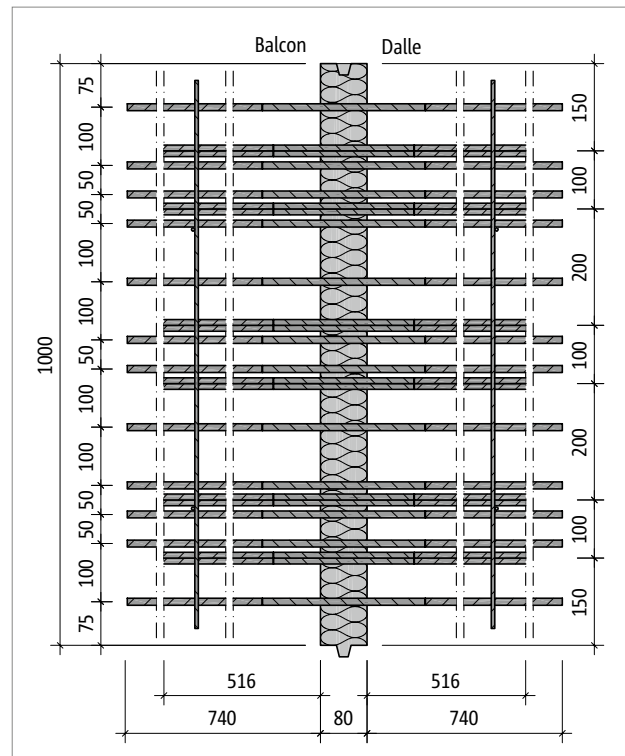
Schöck Rutherma® T type D-MM5-VV3 : vue en plan
